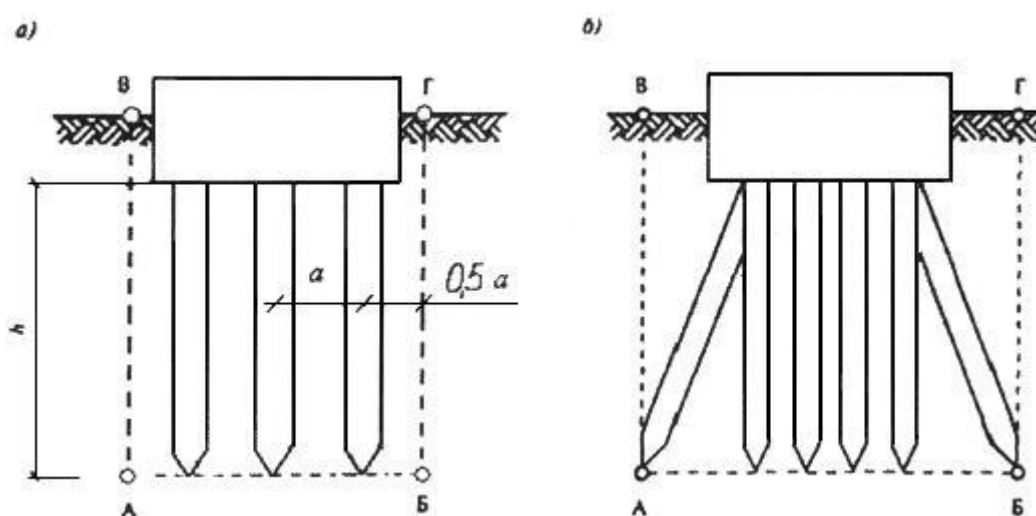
Определение границ условного фундамента при расчёте осадки свайных фундаментов
